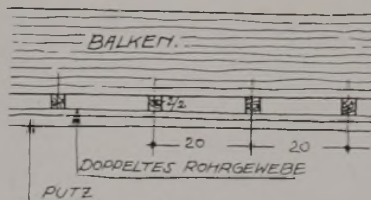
Bessere Konstruktion gegen Risse durch Leisten an den Balkenuntersichten und doppeltes Rohrgewebe, kreuzweise angelegt.
